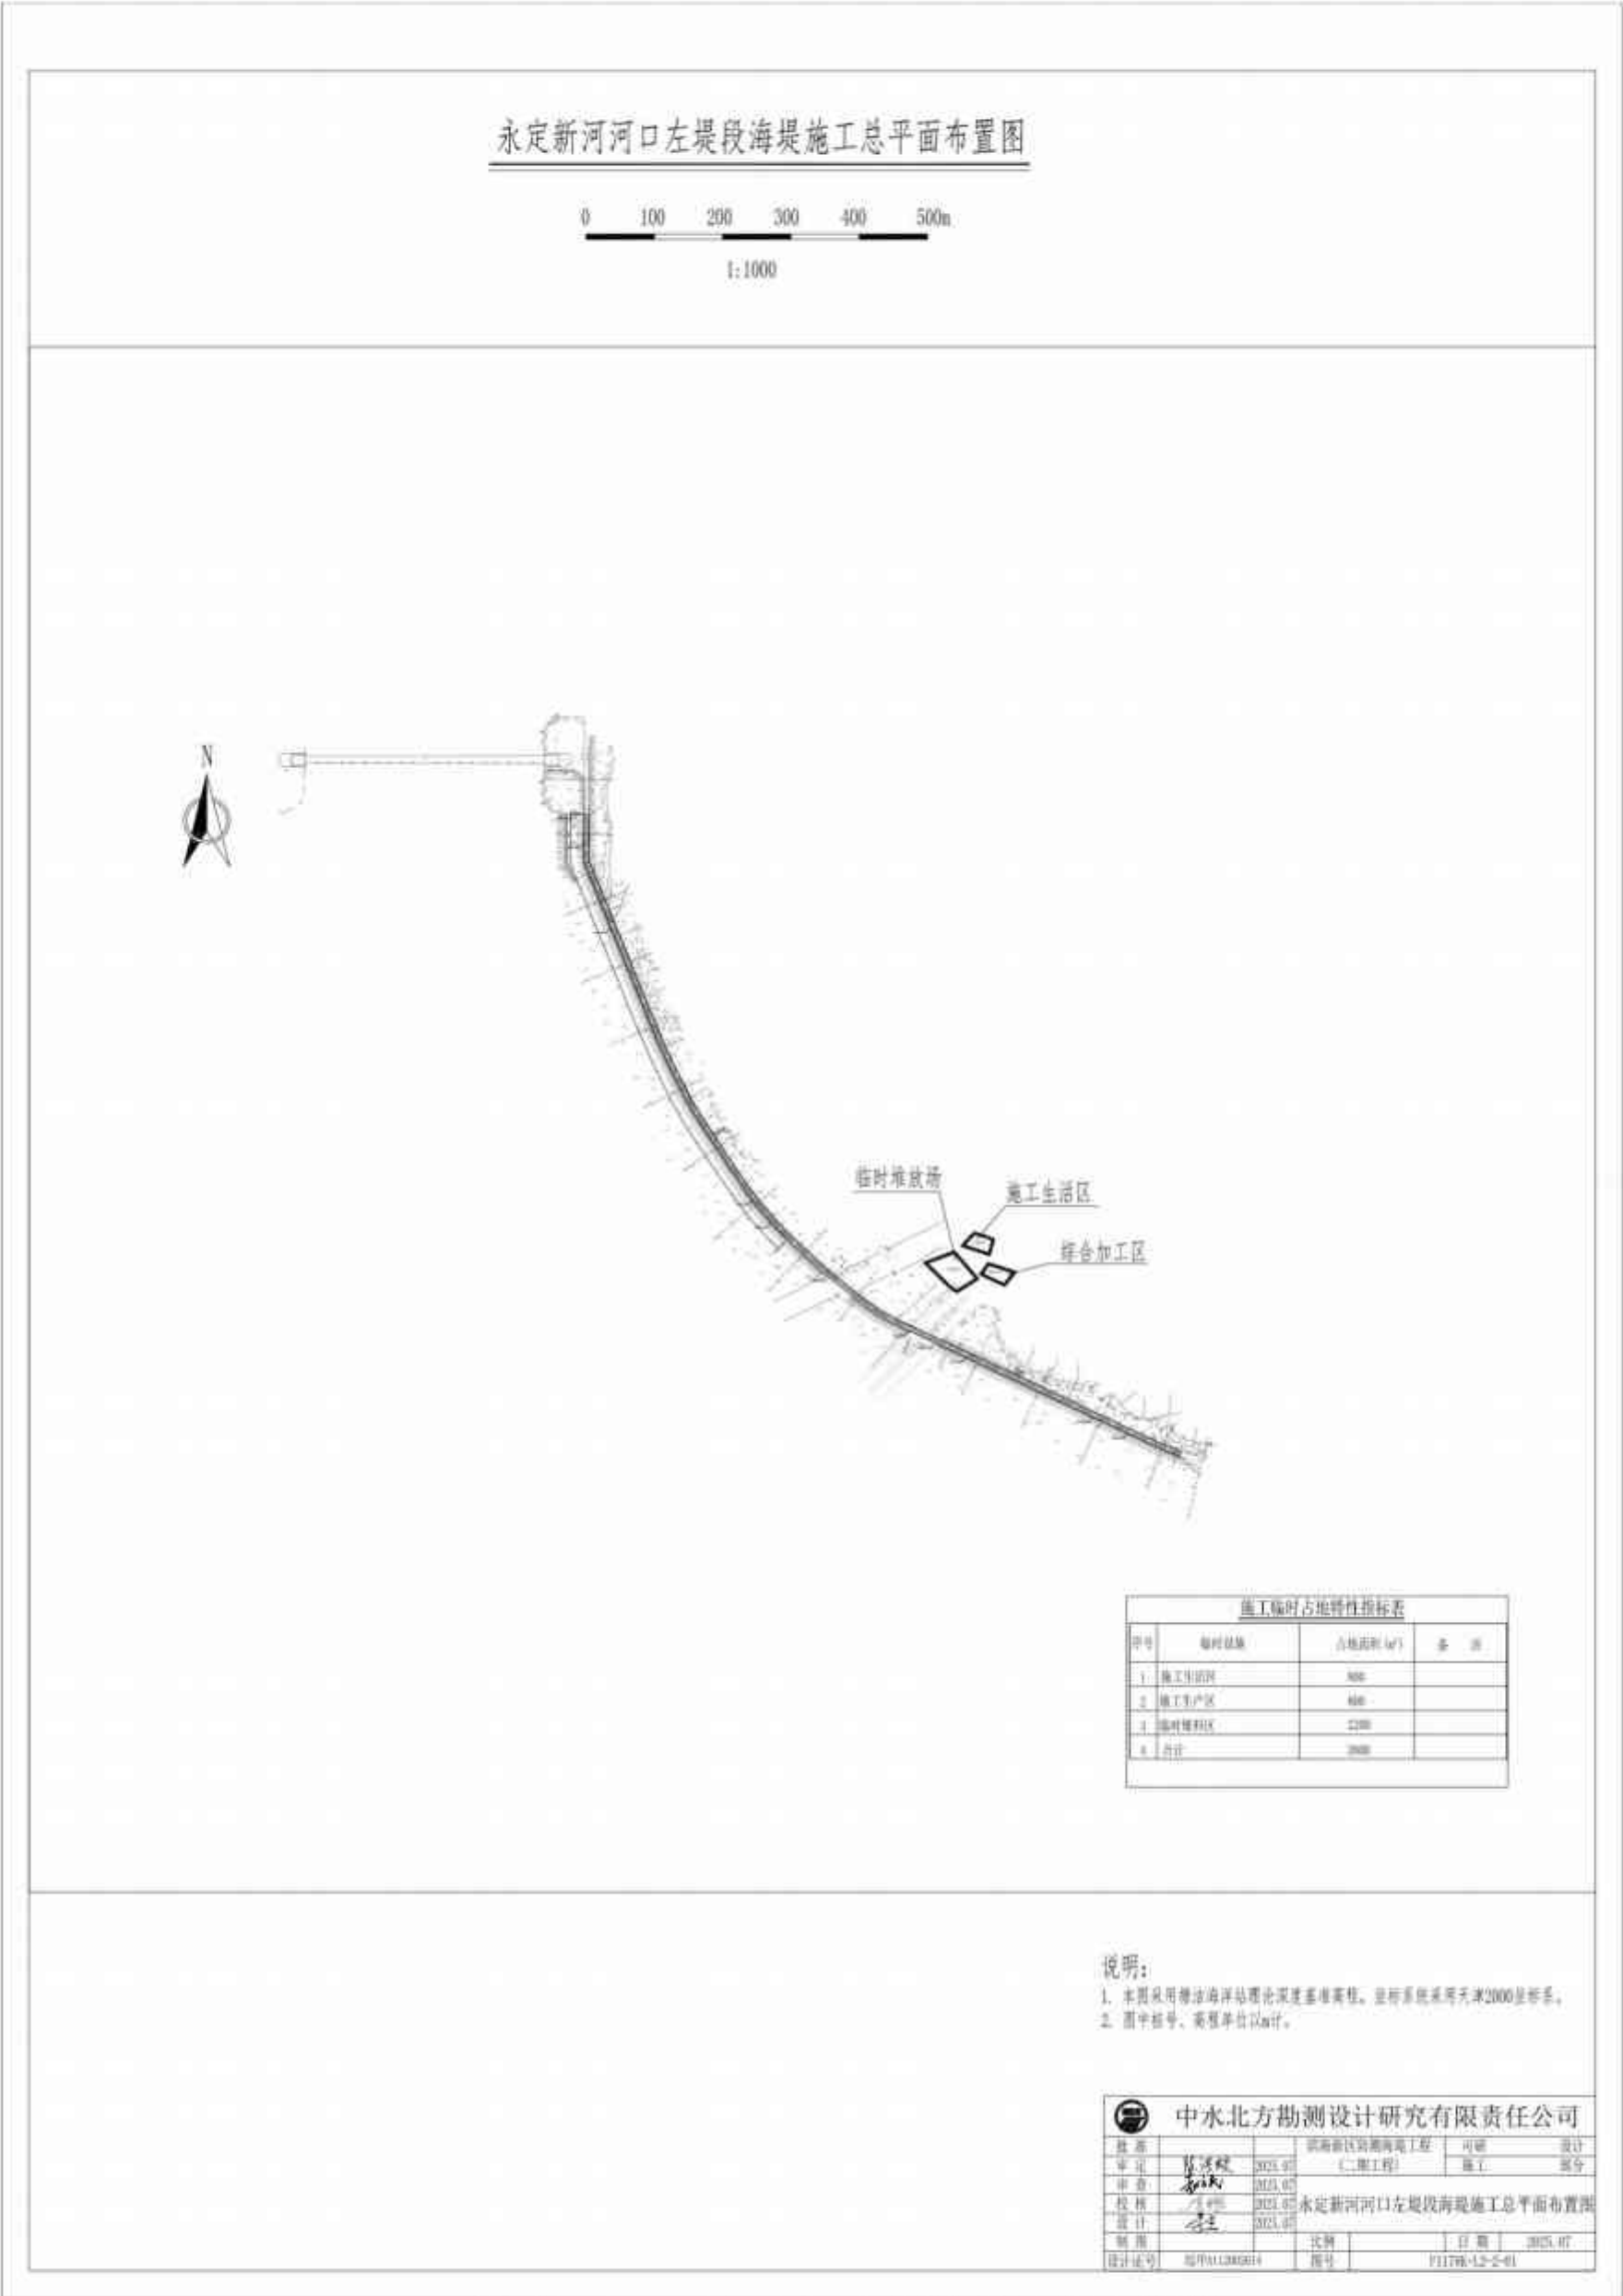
永定河河口左堤段海堤施工总平面布置图
